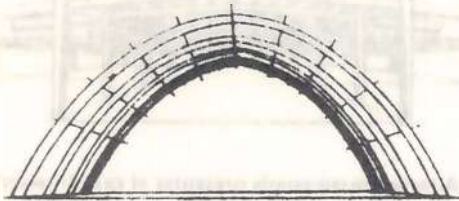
Distintos tipos de elementos estructurales en madera laminada.
